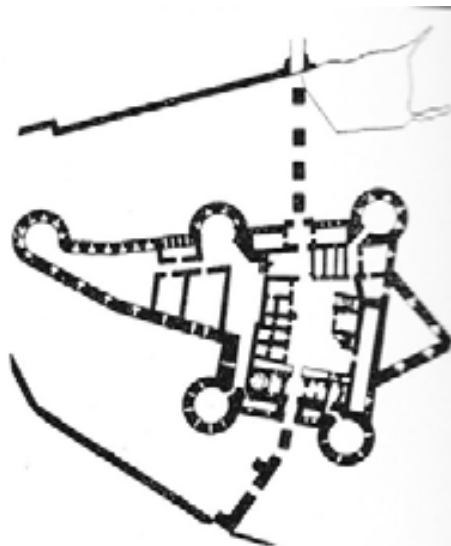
Pianta del castello di Taranto nel 1492 (Speziale G.C., 1930).
